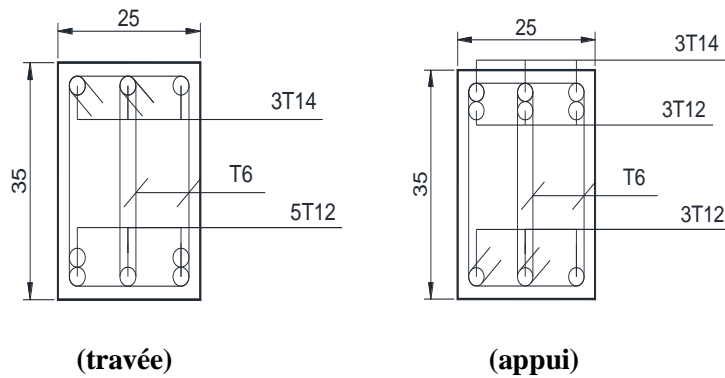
Coupe longitudinale d'une poutre principale 25x35cm (plan régulier)
